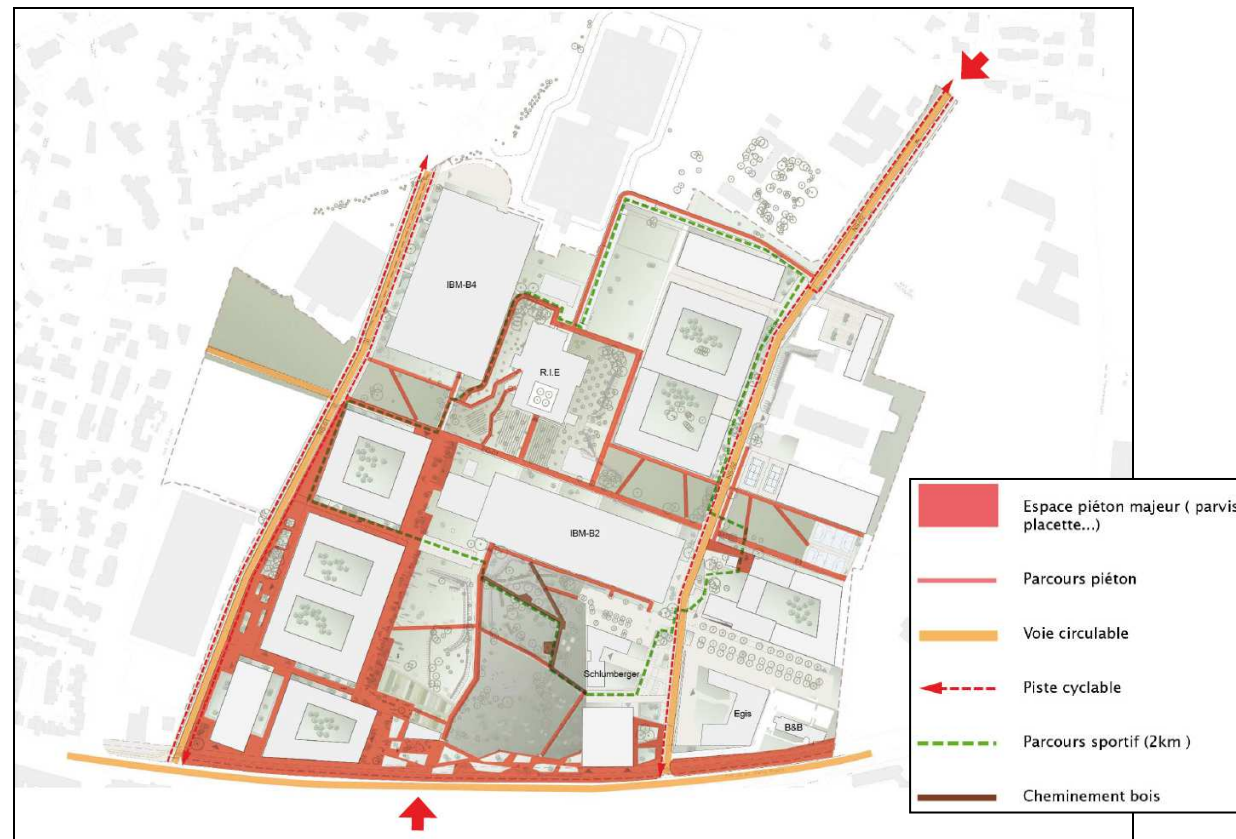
Structure urbaine (Source : Plan Guide, Juillet 2017)
